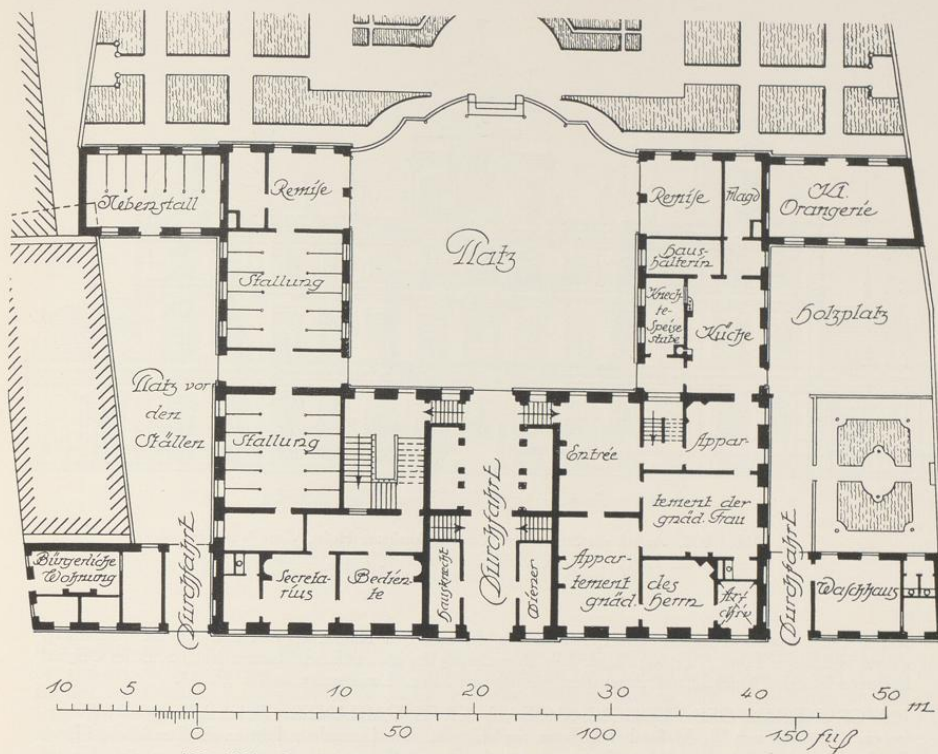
Grundriß des Erdgeschosses des Nordkirchener Hofes, vierte Variante
